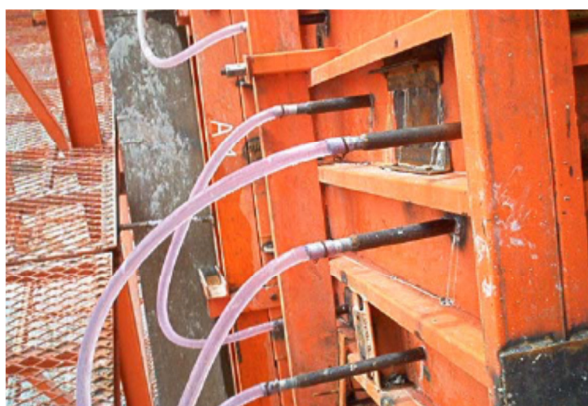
Columna de Puente con Aislación Térmica. (Fuente: Gajda. 2006)
